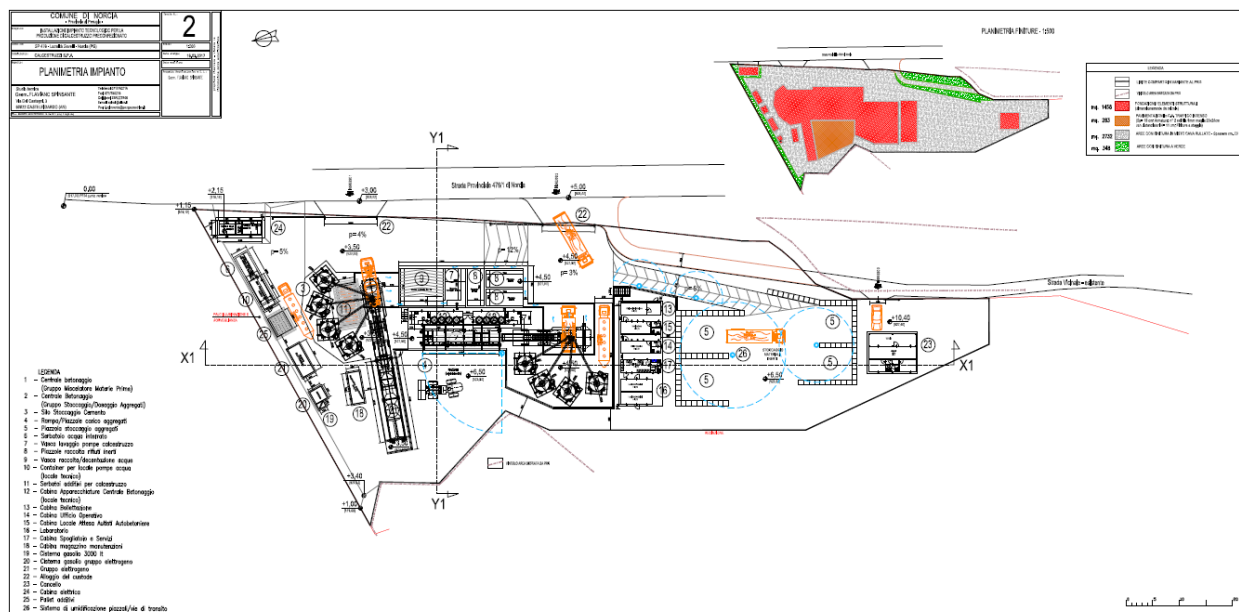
Progetto preliminare dell'impianto di betonaggio – Planimetria generale
